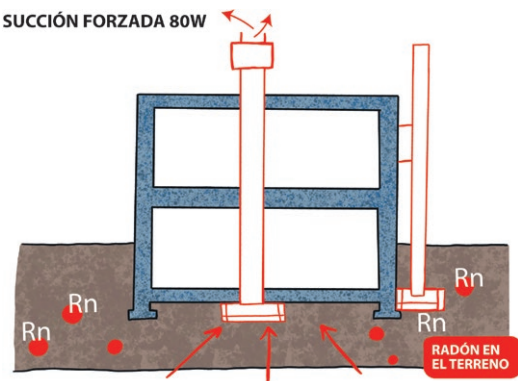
Esquema sistema compuesto de captación, conducción y extracción.
